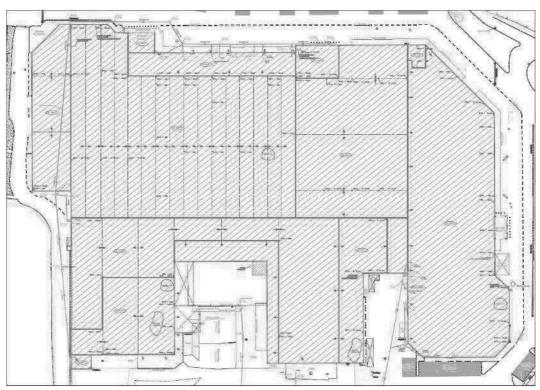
Réseau pluvial de collecte des eaux de toiture
